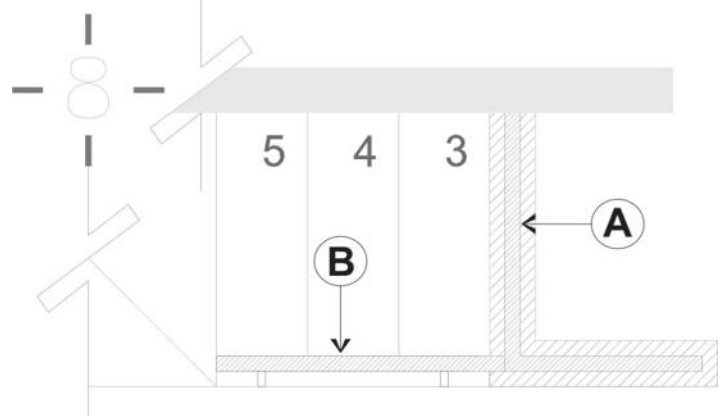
PLANTA QUE MUESTRA LAS PARTES DEL BARANDAL ROBLE.
